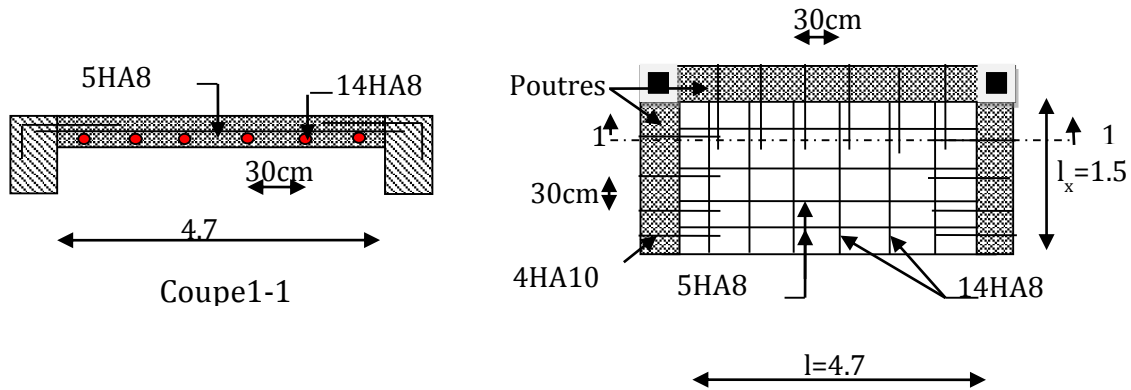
13 : Schéma de ferrailage de la dalle sur trois appuis (étage courant)
